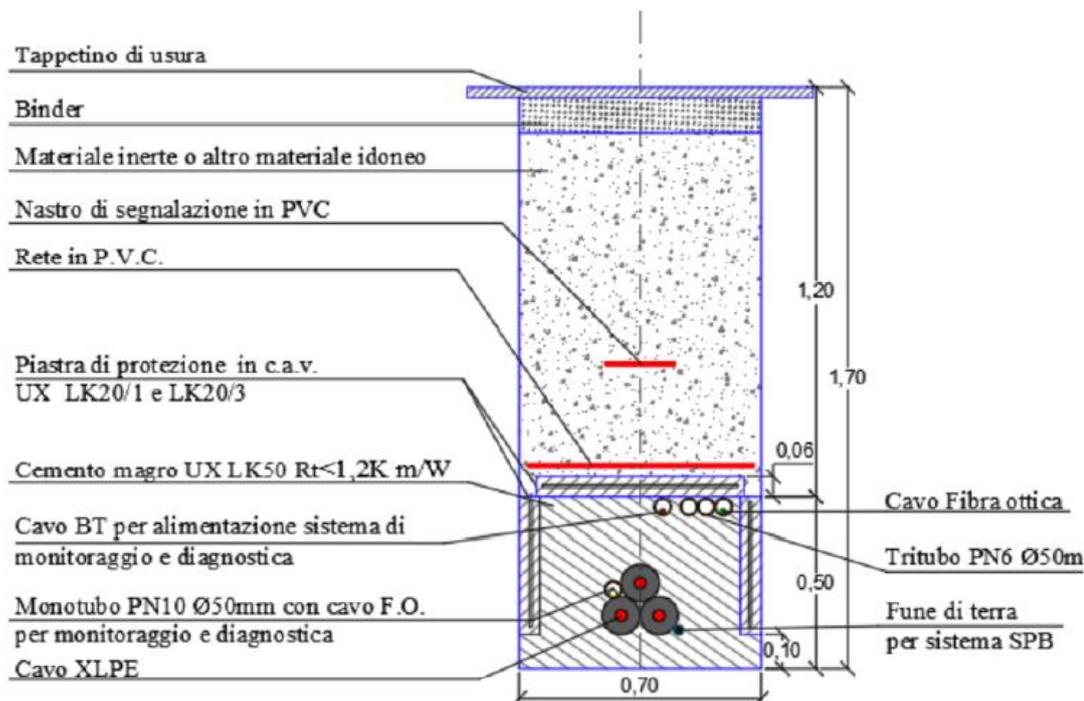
Sezione di posa del cavidotto AT su strada asfaltata
